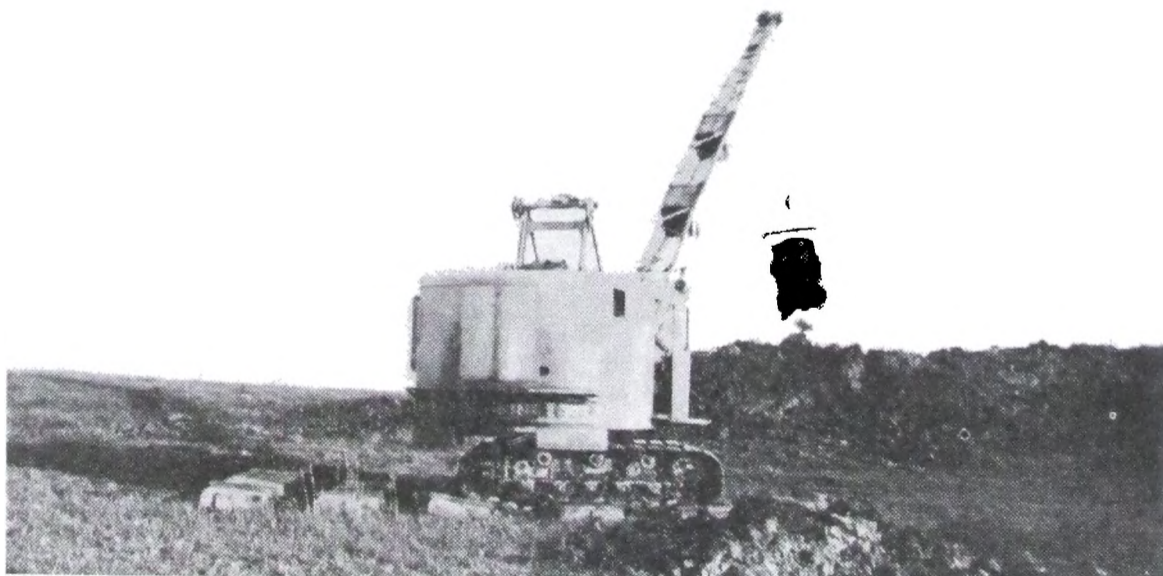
Plan de obras de Castelli. Desviación del Canal «B» al arroyo Corralito. Vista hacia aguas abajo del Hm. 11.
